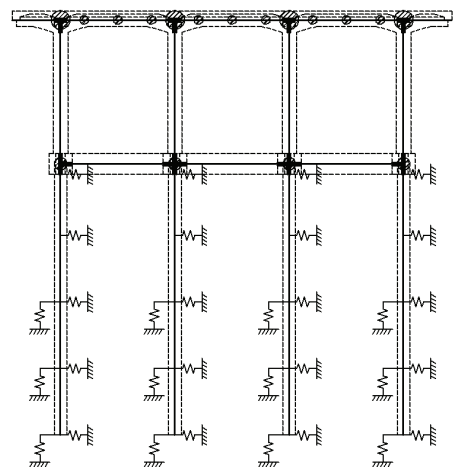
動的非線形解析モデル (地盤, 基礎および上部構造物一体)
